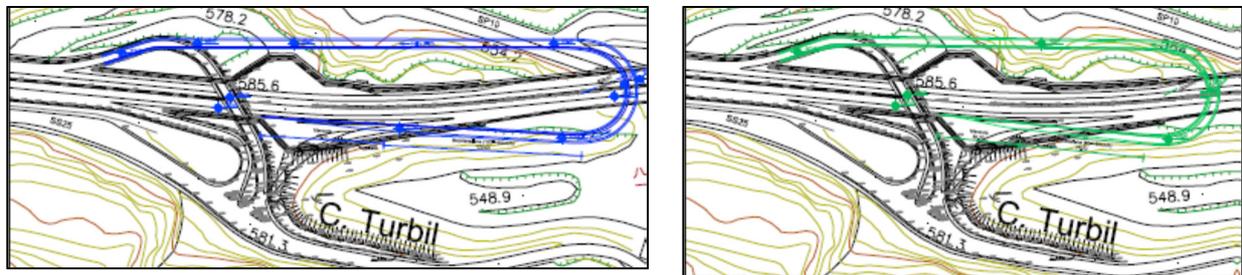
Schemi con rampe di scavalco dell'autostrada
